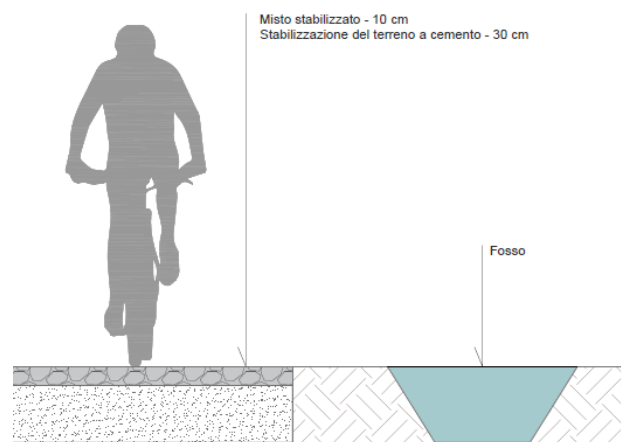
Pacchetto pavimentazione in misto stabilizzato
